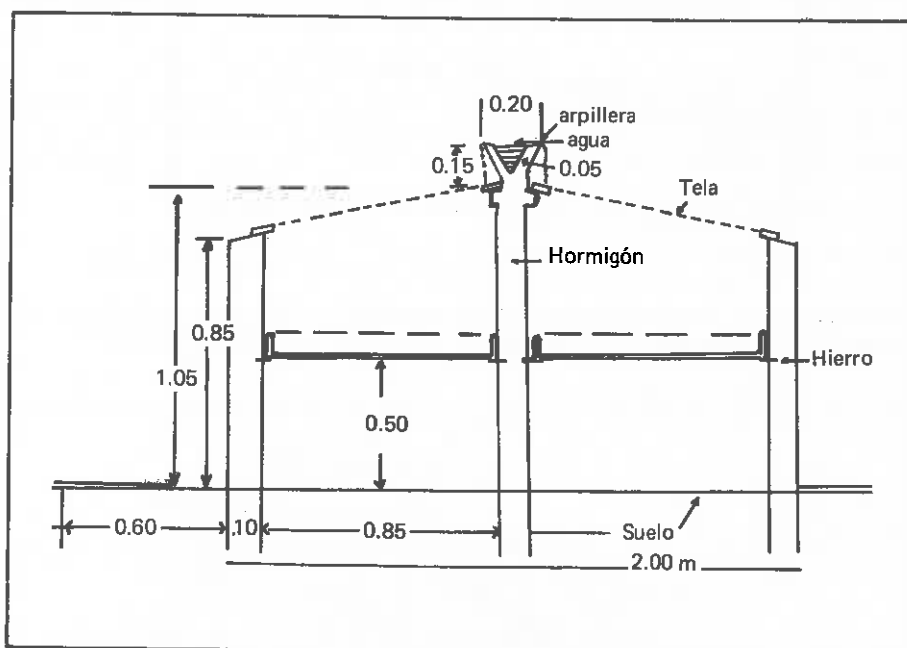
Propagador tipo Turrialba 3: vista transversal con medidas y componentes.
